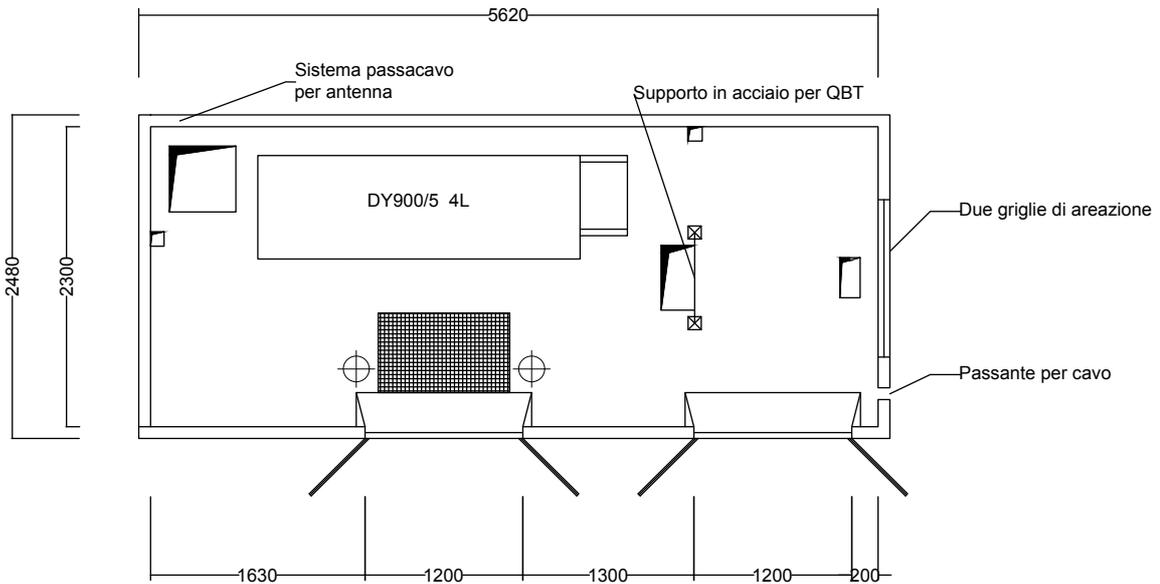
Planimetria cabina di consegna secondo specifica DG2061/1 ed.9
